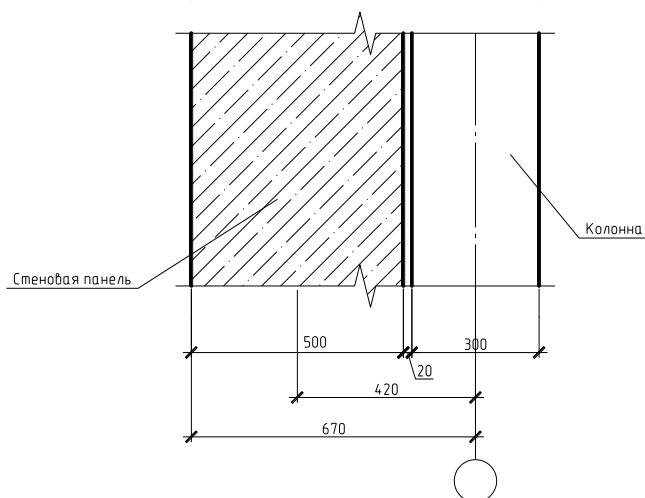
Определение эксцентриситета приложения нагрузок от стеновой панели Н60-13-5
